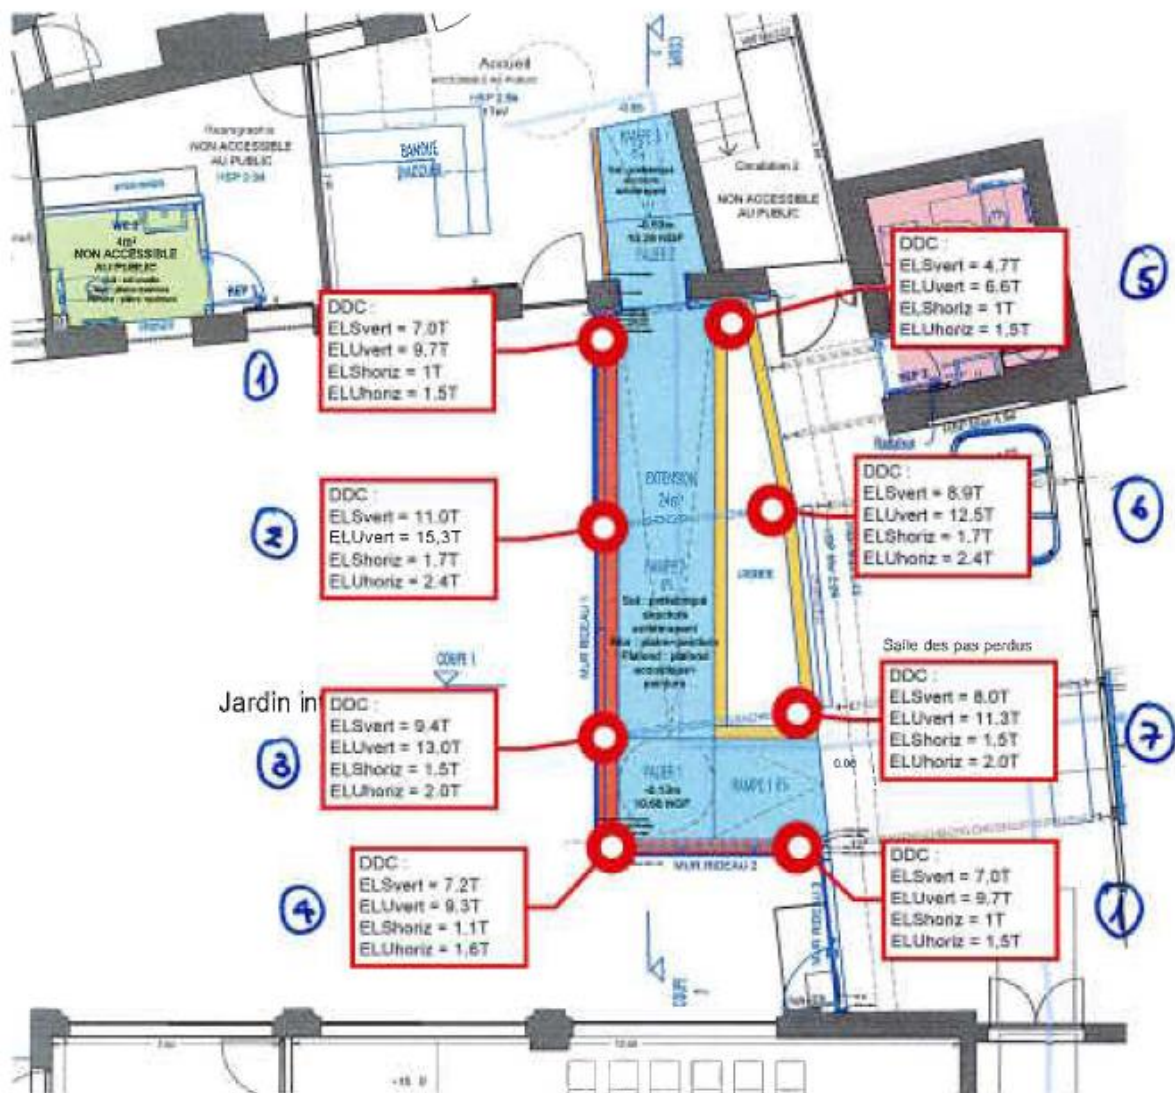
Plan des fondation et descentes de charges (Source : Ar.t architecte)
